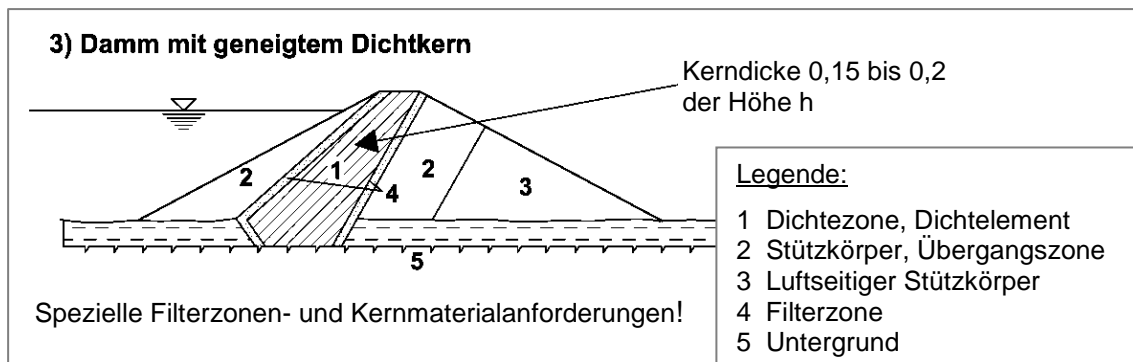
Dammbau mit geneigtem Dichtkern [59: S. 24]
